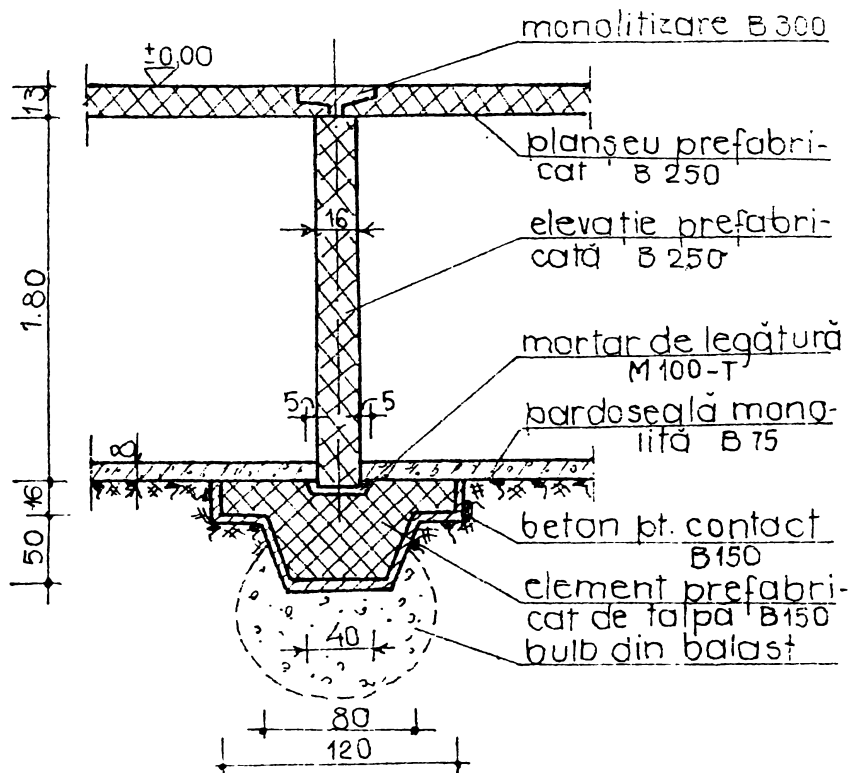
Infrastructuri cu fundații discontinue prefabricate cu placă antirefulantă. (autor ATEF DRAK AL-SEBAI)
